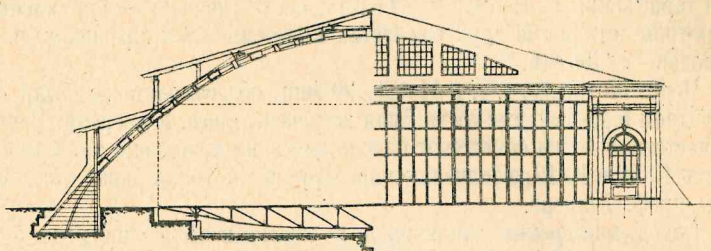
Поперечный разрез и фасад ангара аэро-порта в Харькове.
